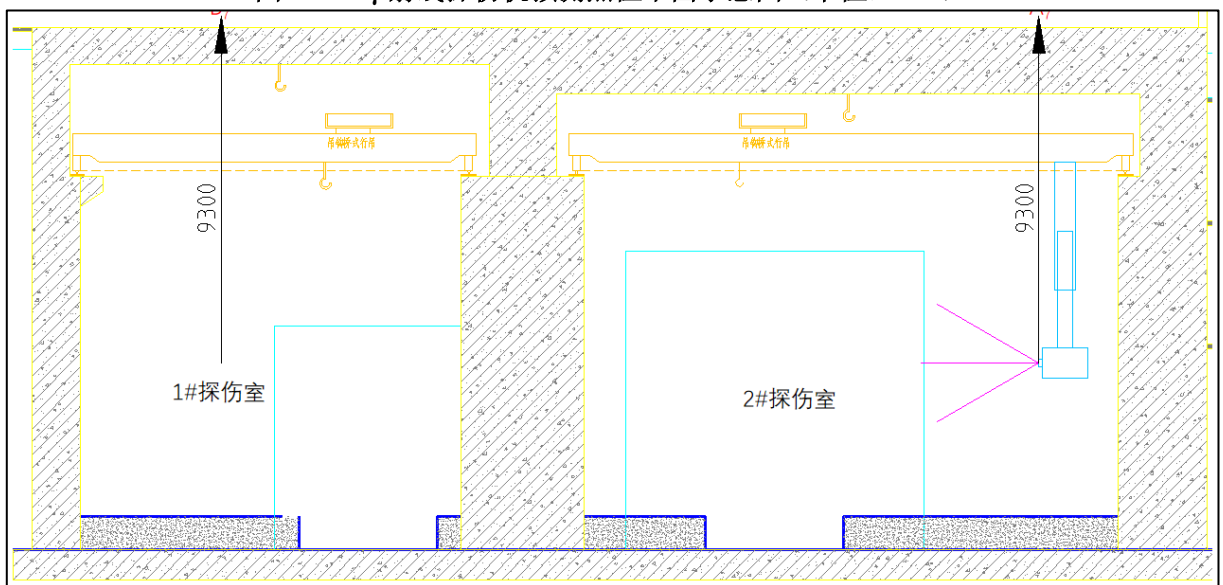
探伤室预测点位剖面示意图 (单位: mm)
